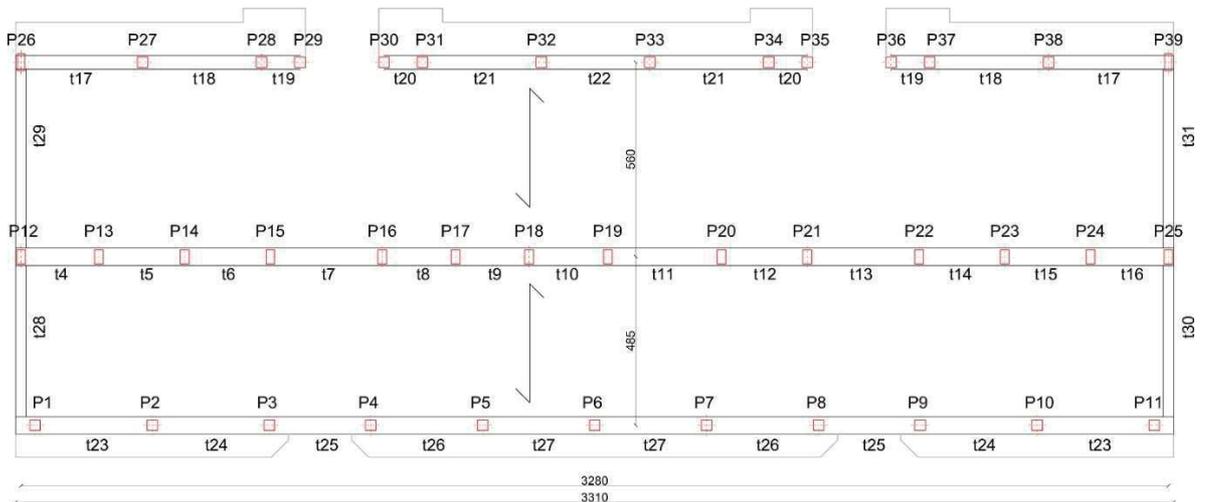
Pianta piano tipo ricostruita – pilastri e travi
